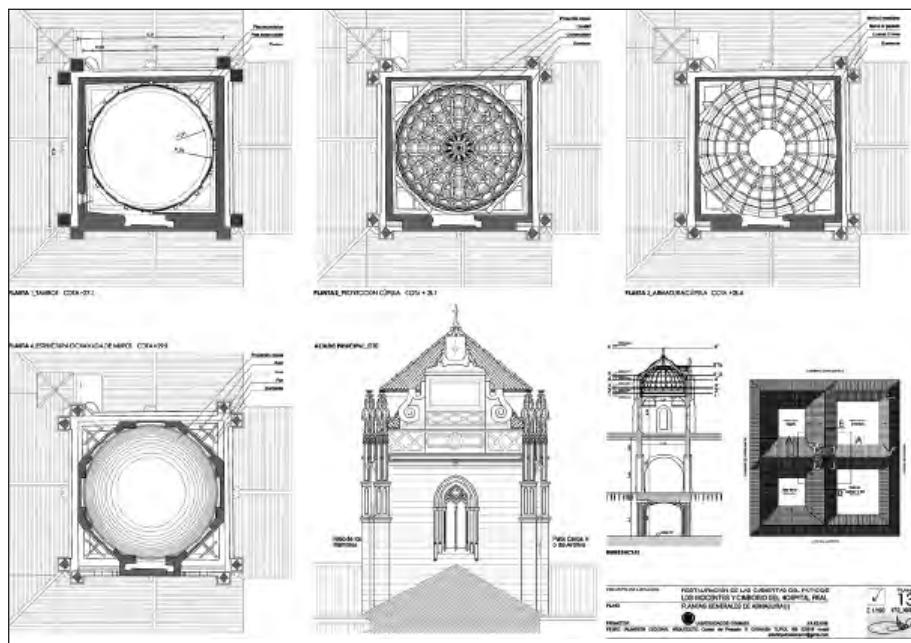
Plantas, alzado y sección del cimborrio del Hospital Real de Granada (Pedro Salmerón).
